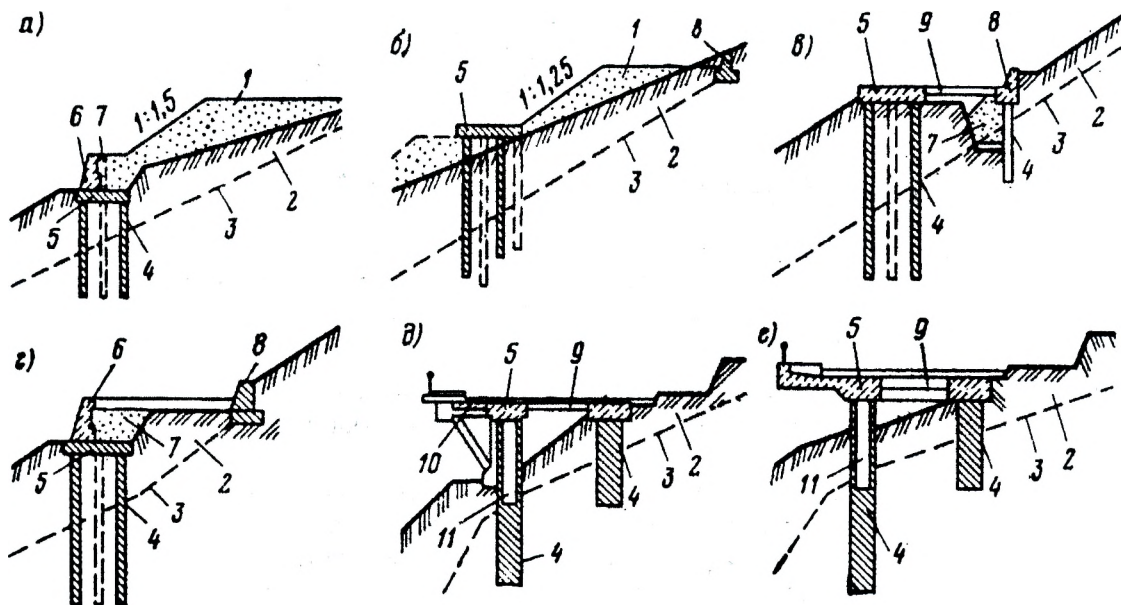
Схемы закрепления земляного полотна бетонными сваями на оползающем участке дороги: а – насыпь с низовой подпорной стенкой на свайном ростверке; б – насыпь с опорным свайным ростверком у подошвы; в, г – дорога на полке со свайным ростверком, соединенным горизонтальной анкерной тягой с верховой подпорной стеной; д, е – противооползневые конструкции в виде балконов и эстакад; 1 – насыпь; 2 – оползающий массив грунта; 3 – поверхность скольжения; 4 – буронабивные железобетонные сваи; 5 – железобетонный ростверк; 6 – низовая подпорная стенка; 7 – дренаж; 8 – верховая подпорная стенка; 9 – анкерная тяга; 10 – железобетонный балкон; 11 – сваи-заполнители между несущими сваями
